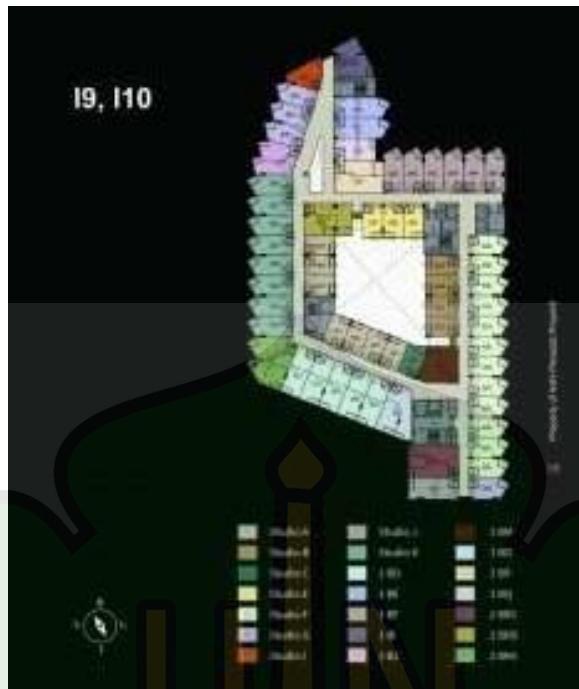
Denah Lantai 4 dan Lantai 5 Apartemen Dhika Universe
